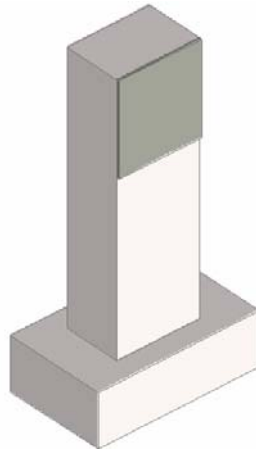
Confinamento do betão com colagem de chapas metálicas.
